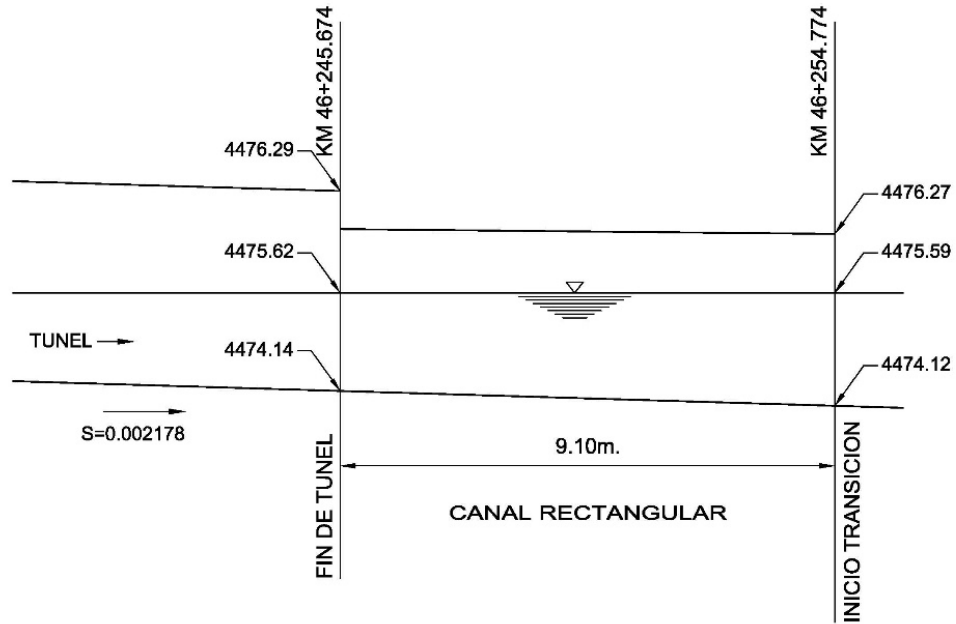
Perfil longitudinal del tramo de sección rectangular
